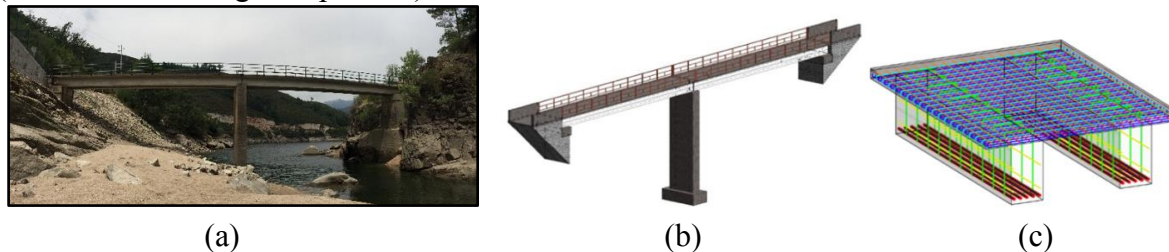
a) Aspeto geral da Ponte do Saltadouro; b) vista geral do modelo BIM; c) pormenor de armaduras numa parte do modelo
